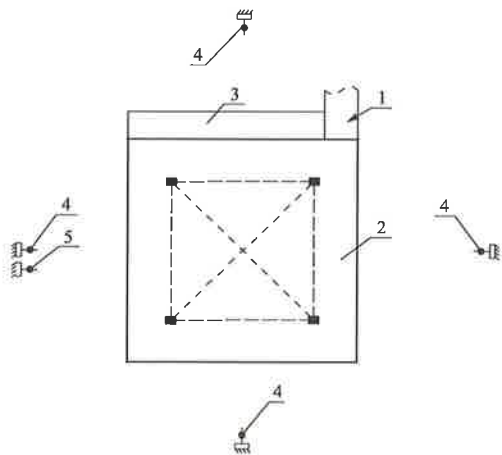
内悬浮内拉线抱杆分解组塔现场平面布置示意图
